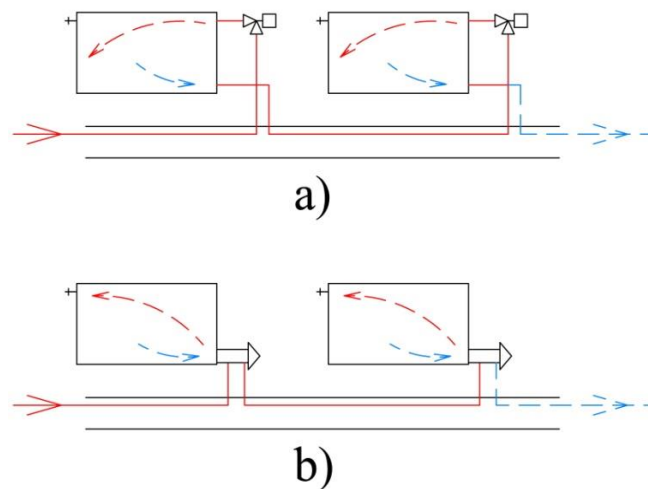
Dvoutrubková otopná soustava s horizontálním rozvodem k otopným tělesům:
